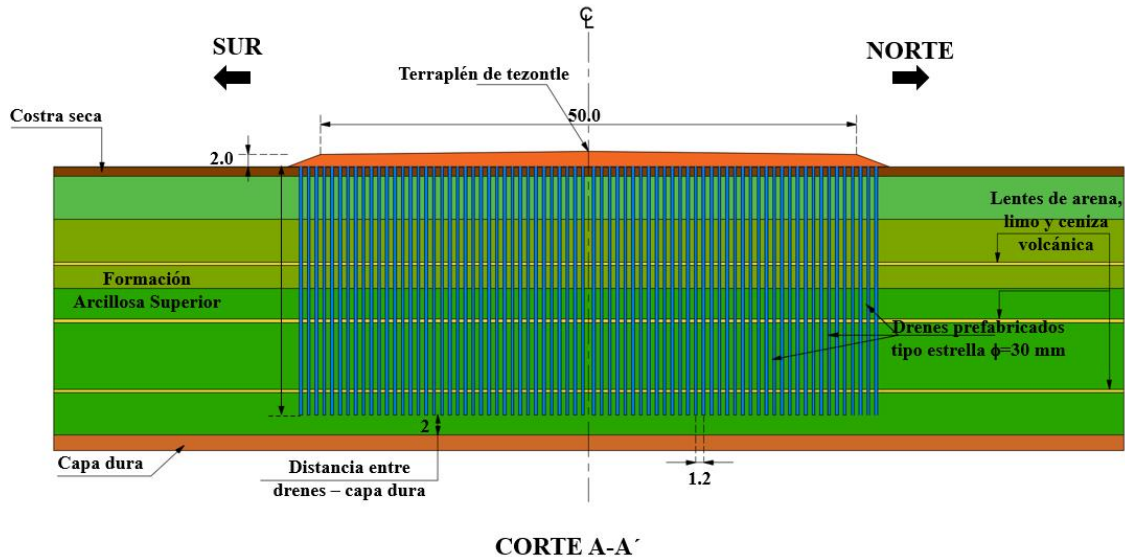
Terraplén de precarga y vacío dren a dren.
